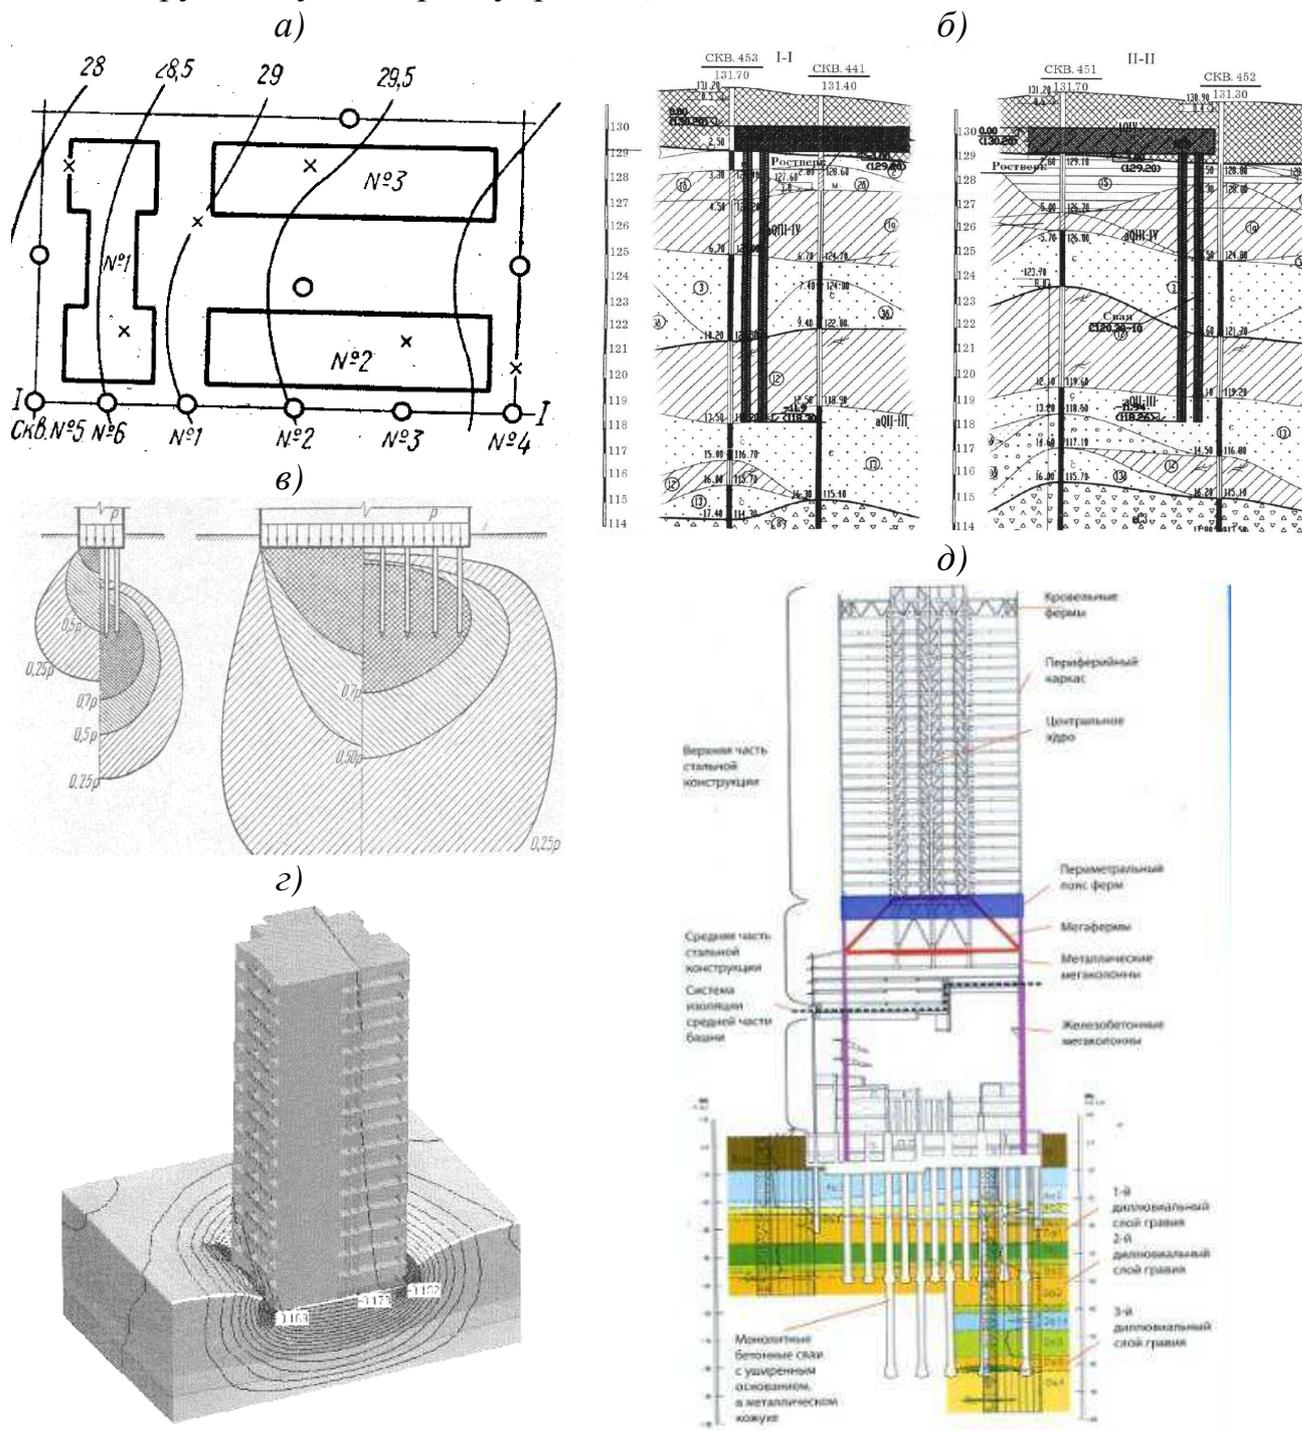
Схемы к результатам топогеодезических и инженерно-геологических изысканий строительной площадки высотного здания: *а* – план строительной площадки с обозначением горизонталей и нанесенными контурами проектируемых зданий и мест расположения инженерно-геологических выработок (скважин); *б* – инженерно-геологические разрезы, совмещенные с разрезами по фундаментам; *в* – зоны развития напряжений в массиве грунта основания под разными типами фундаментов для учета влияния на окружающую застройку; *г* – деформационные схемы и изолинии осадок зданий и окружающего грунта; *д* – совмещенный разрез здания с геологическим разрезом
